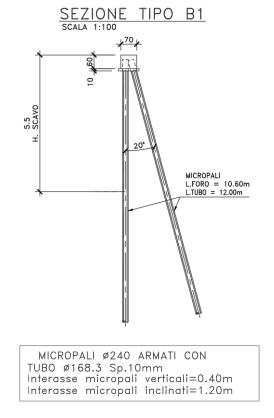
Sezione Paratia "Sezione tipo B1"
